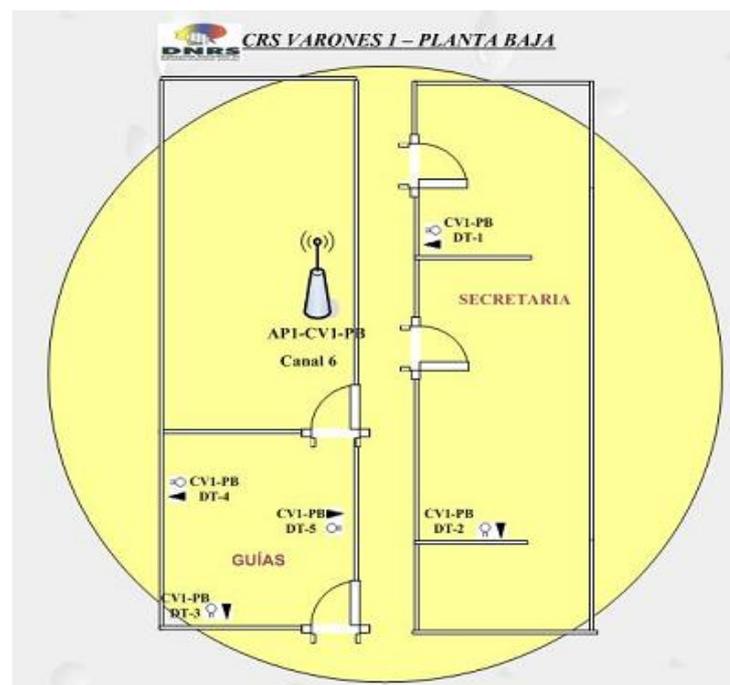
Red Inalámbrica Planta Baja CRS Varones 1
